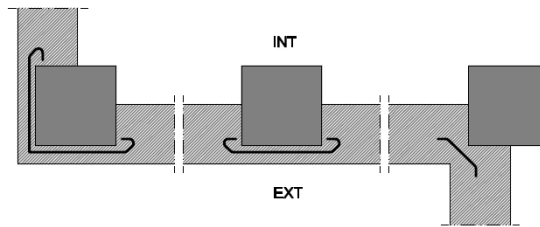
Ejemplo de encuentro de la fachada con los pilares
